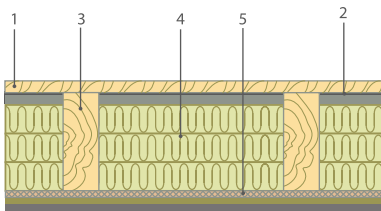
Утепление перекрытия по деревянным балкам над холодным подвалом:
